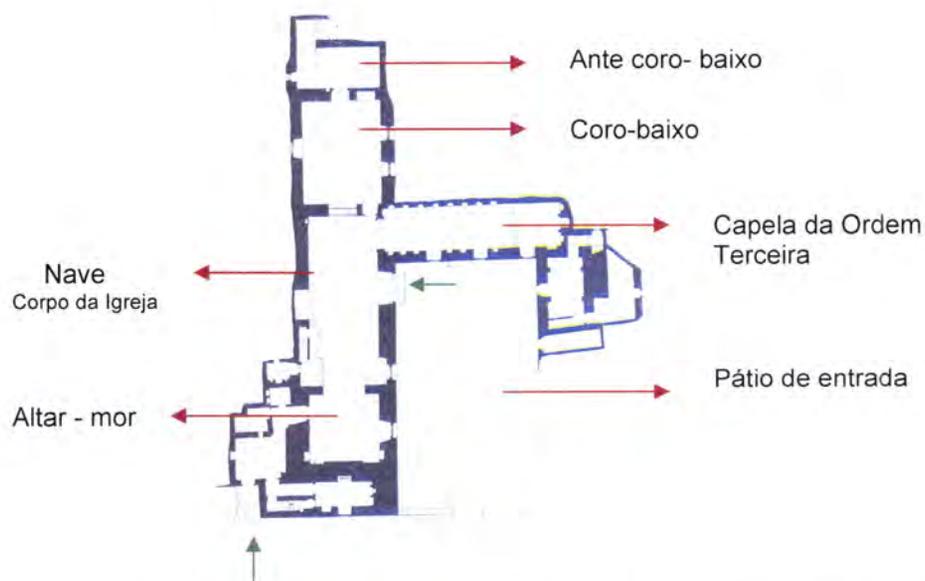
Planta do interior do Convento (referente ao que existe actualmente)
